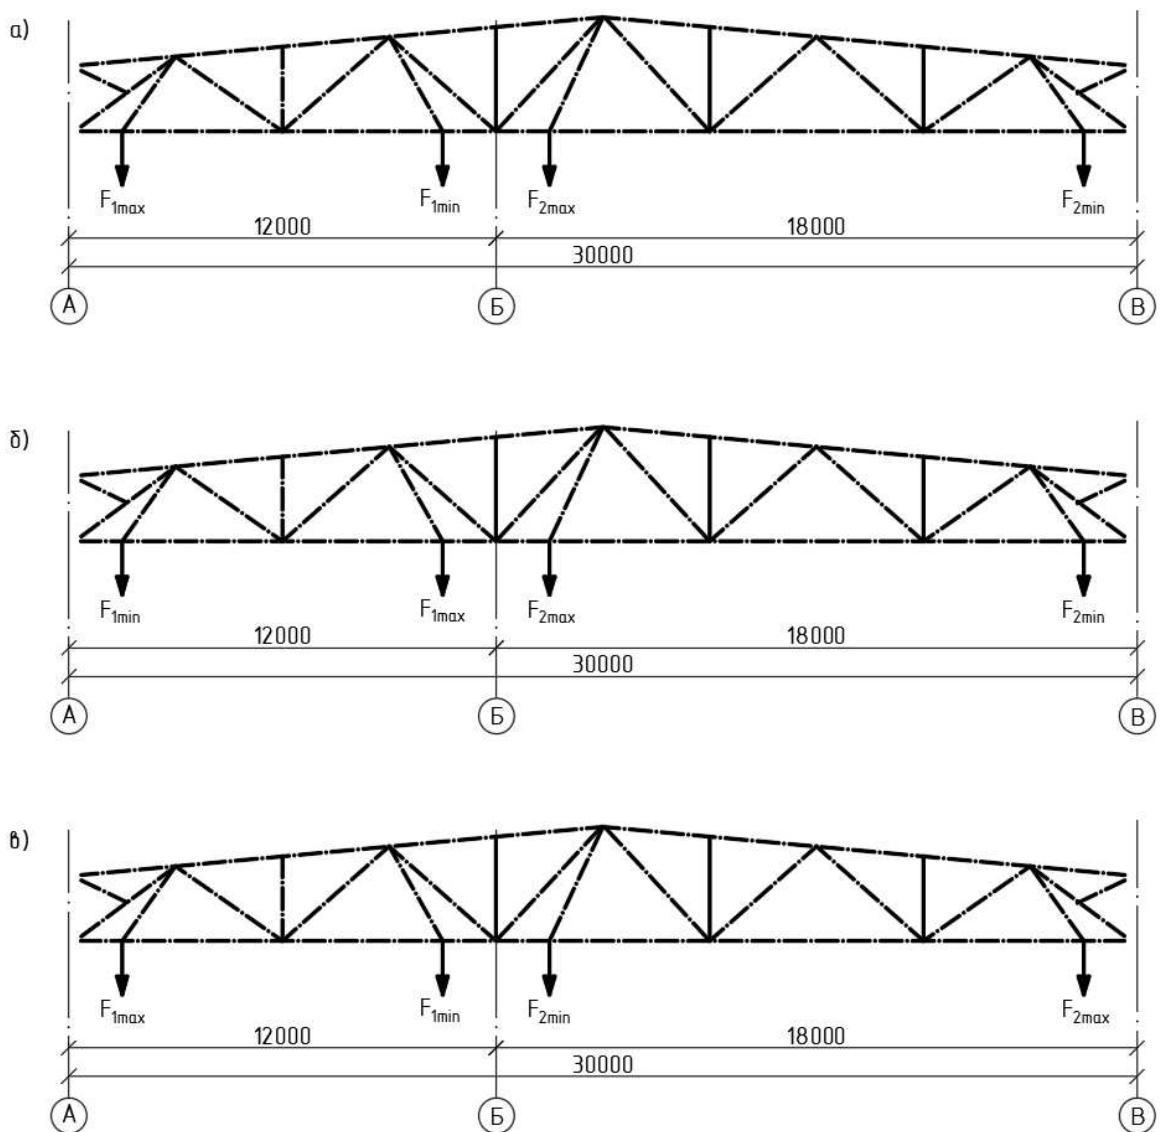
Схемы загружений стропильной фермы нагрузкой от подвесных кранов
